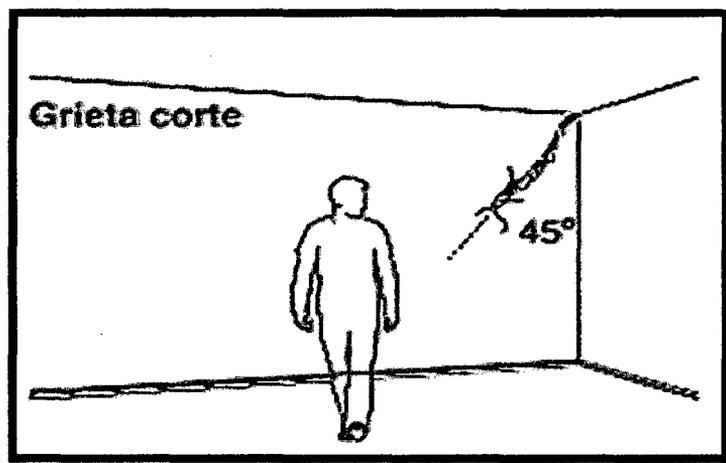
Grieta por Corte (Vigouroux 2010)
